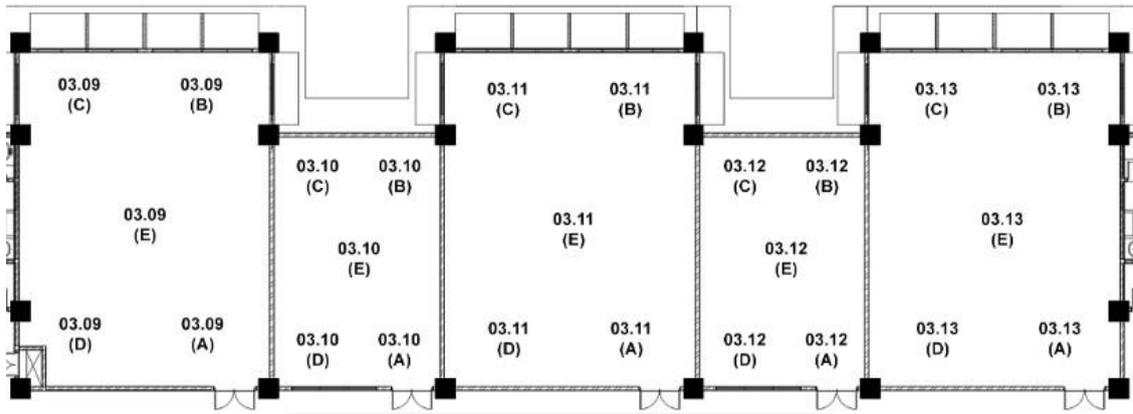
Denah lantai 3 Gedung FTI UII
